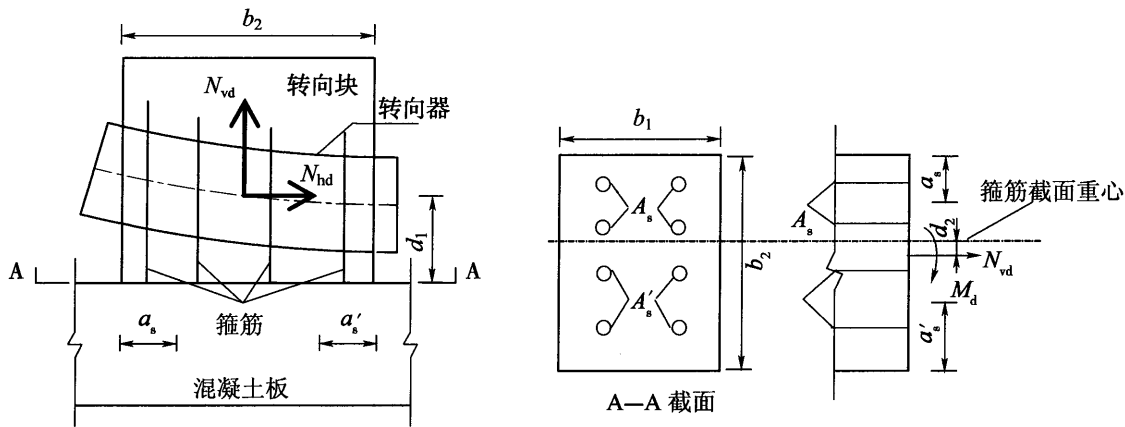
混凝土转向块抗拉承载力计算图式
